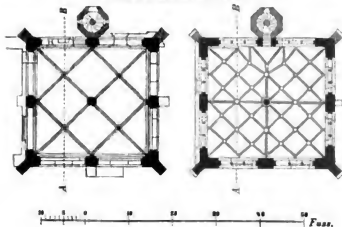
Grundrisse. (Nach dem Restaurations-Entwurf No. 4).
